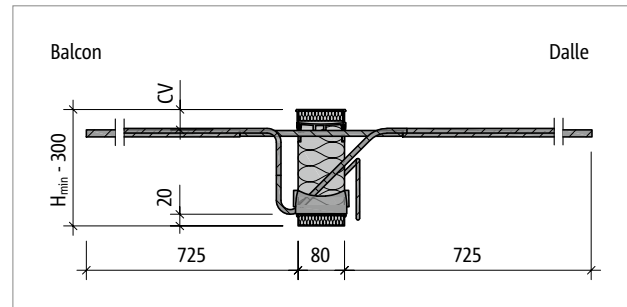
Schöck Isokorb® T types K-E-M6, K-T-M7, K-T-M9, K-T-M10 : coupe du produit
